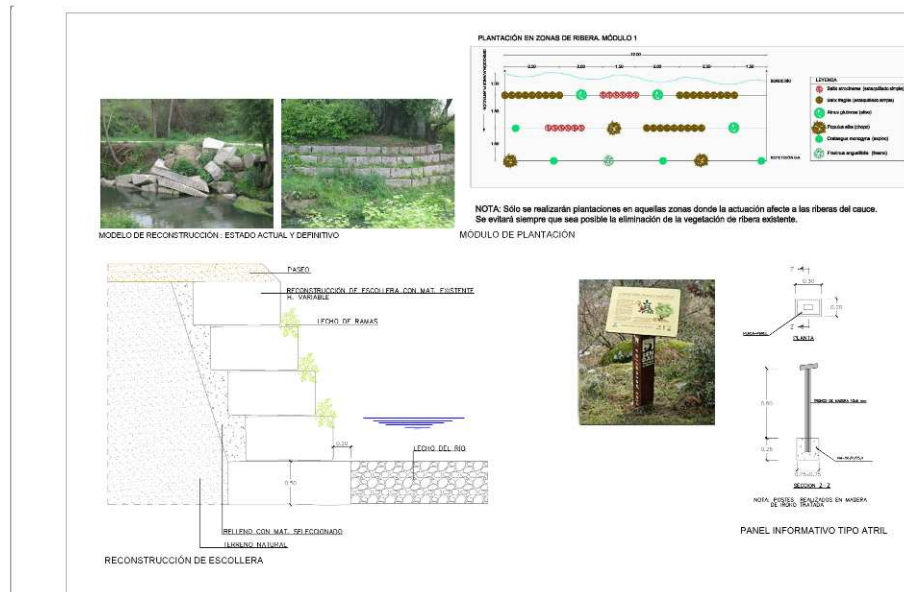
Secciones tipo reconstrucción de escollera y esquema de plantaciones
